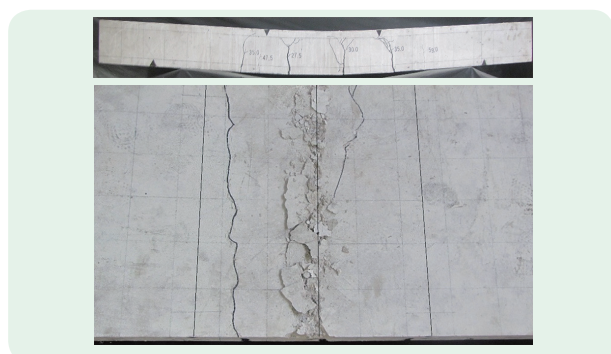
ビス穴なし試験体の破壊状況 (上:側面 下:平面)
